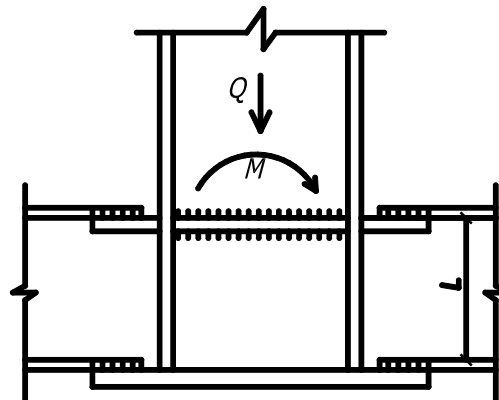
Схема работы безбазового узла крепления колонны к фундаменту
